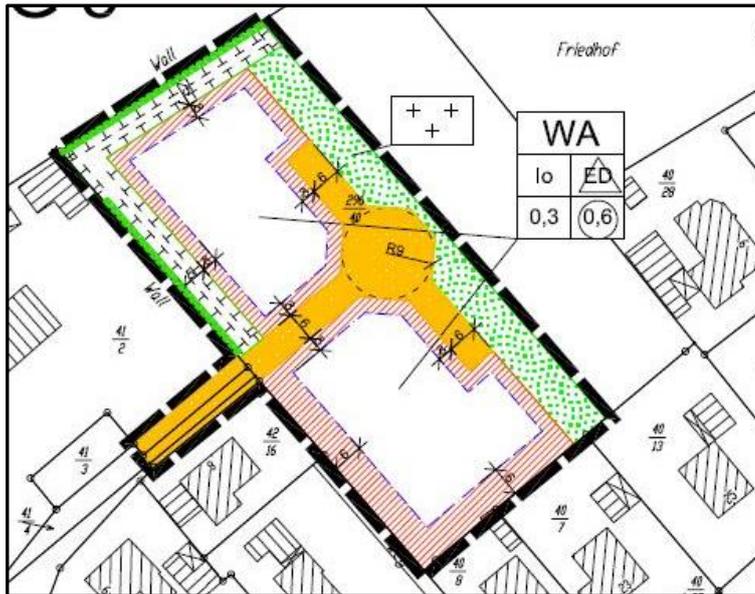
Bebauungsplan Nr. G5, 2. Änderung
